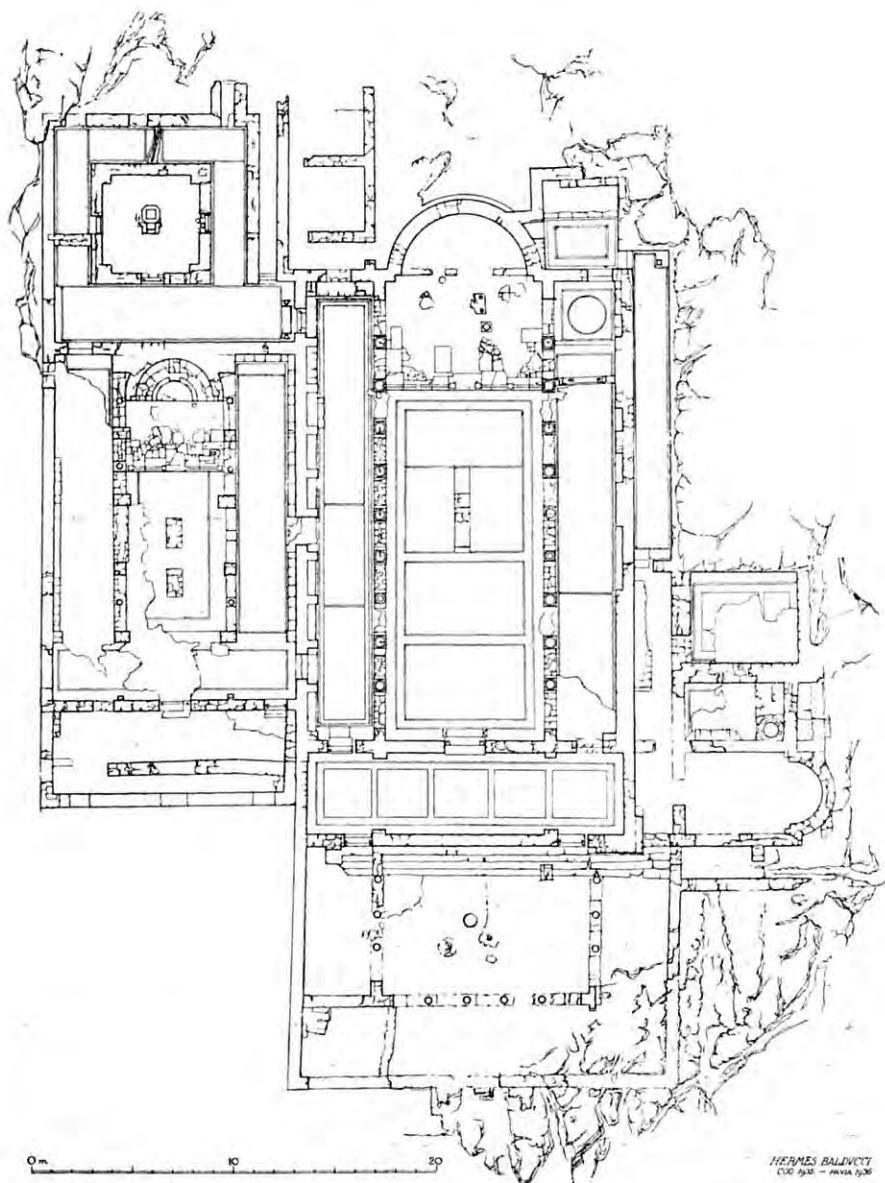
Planimetria delle basiliche di Santo Stefano.
